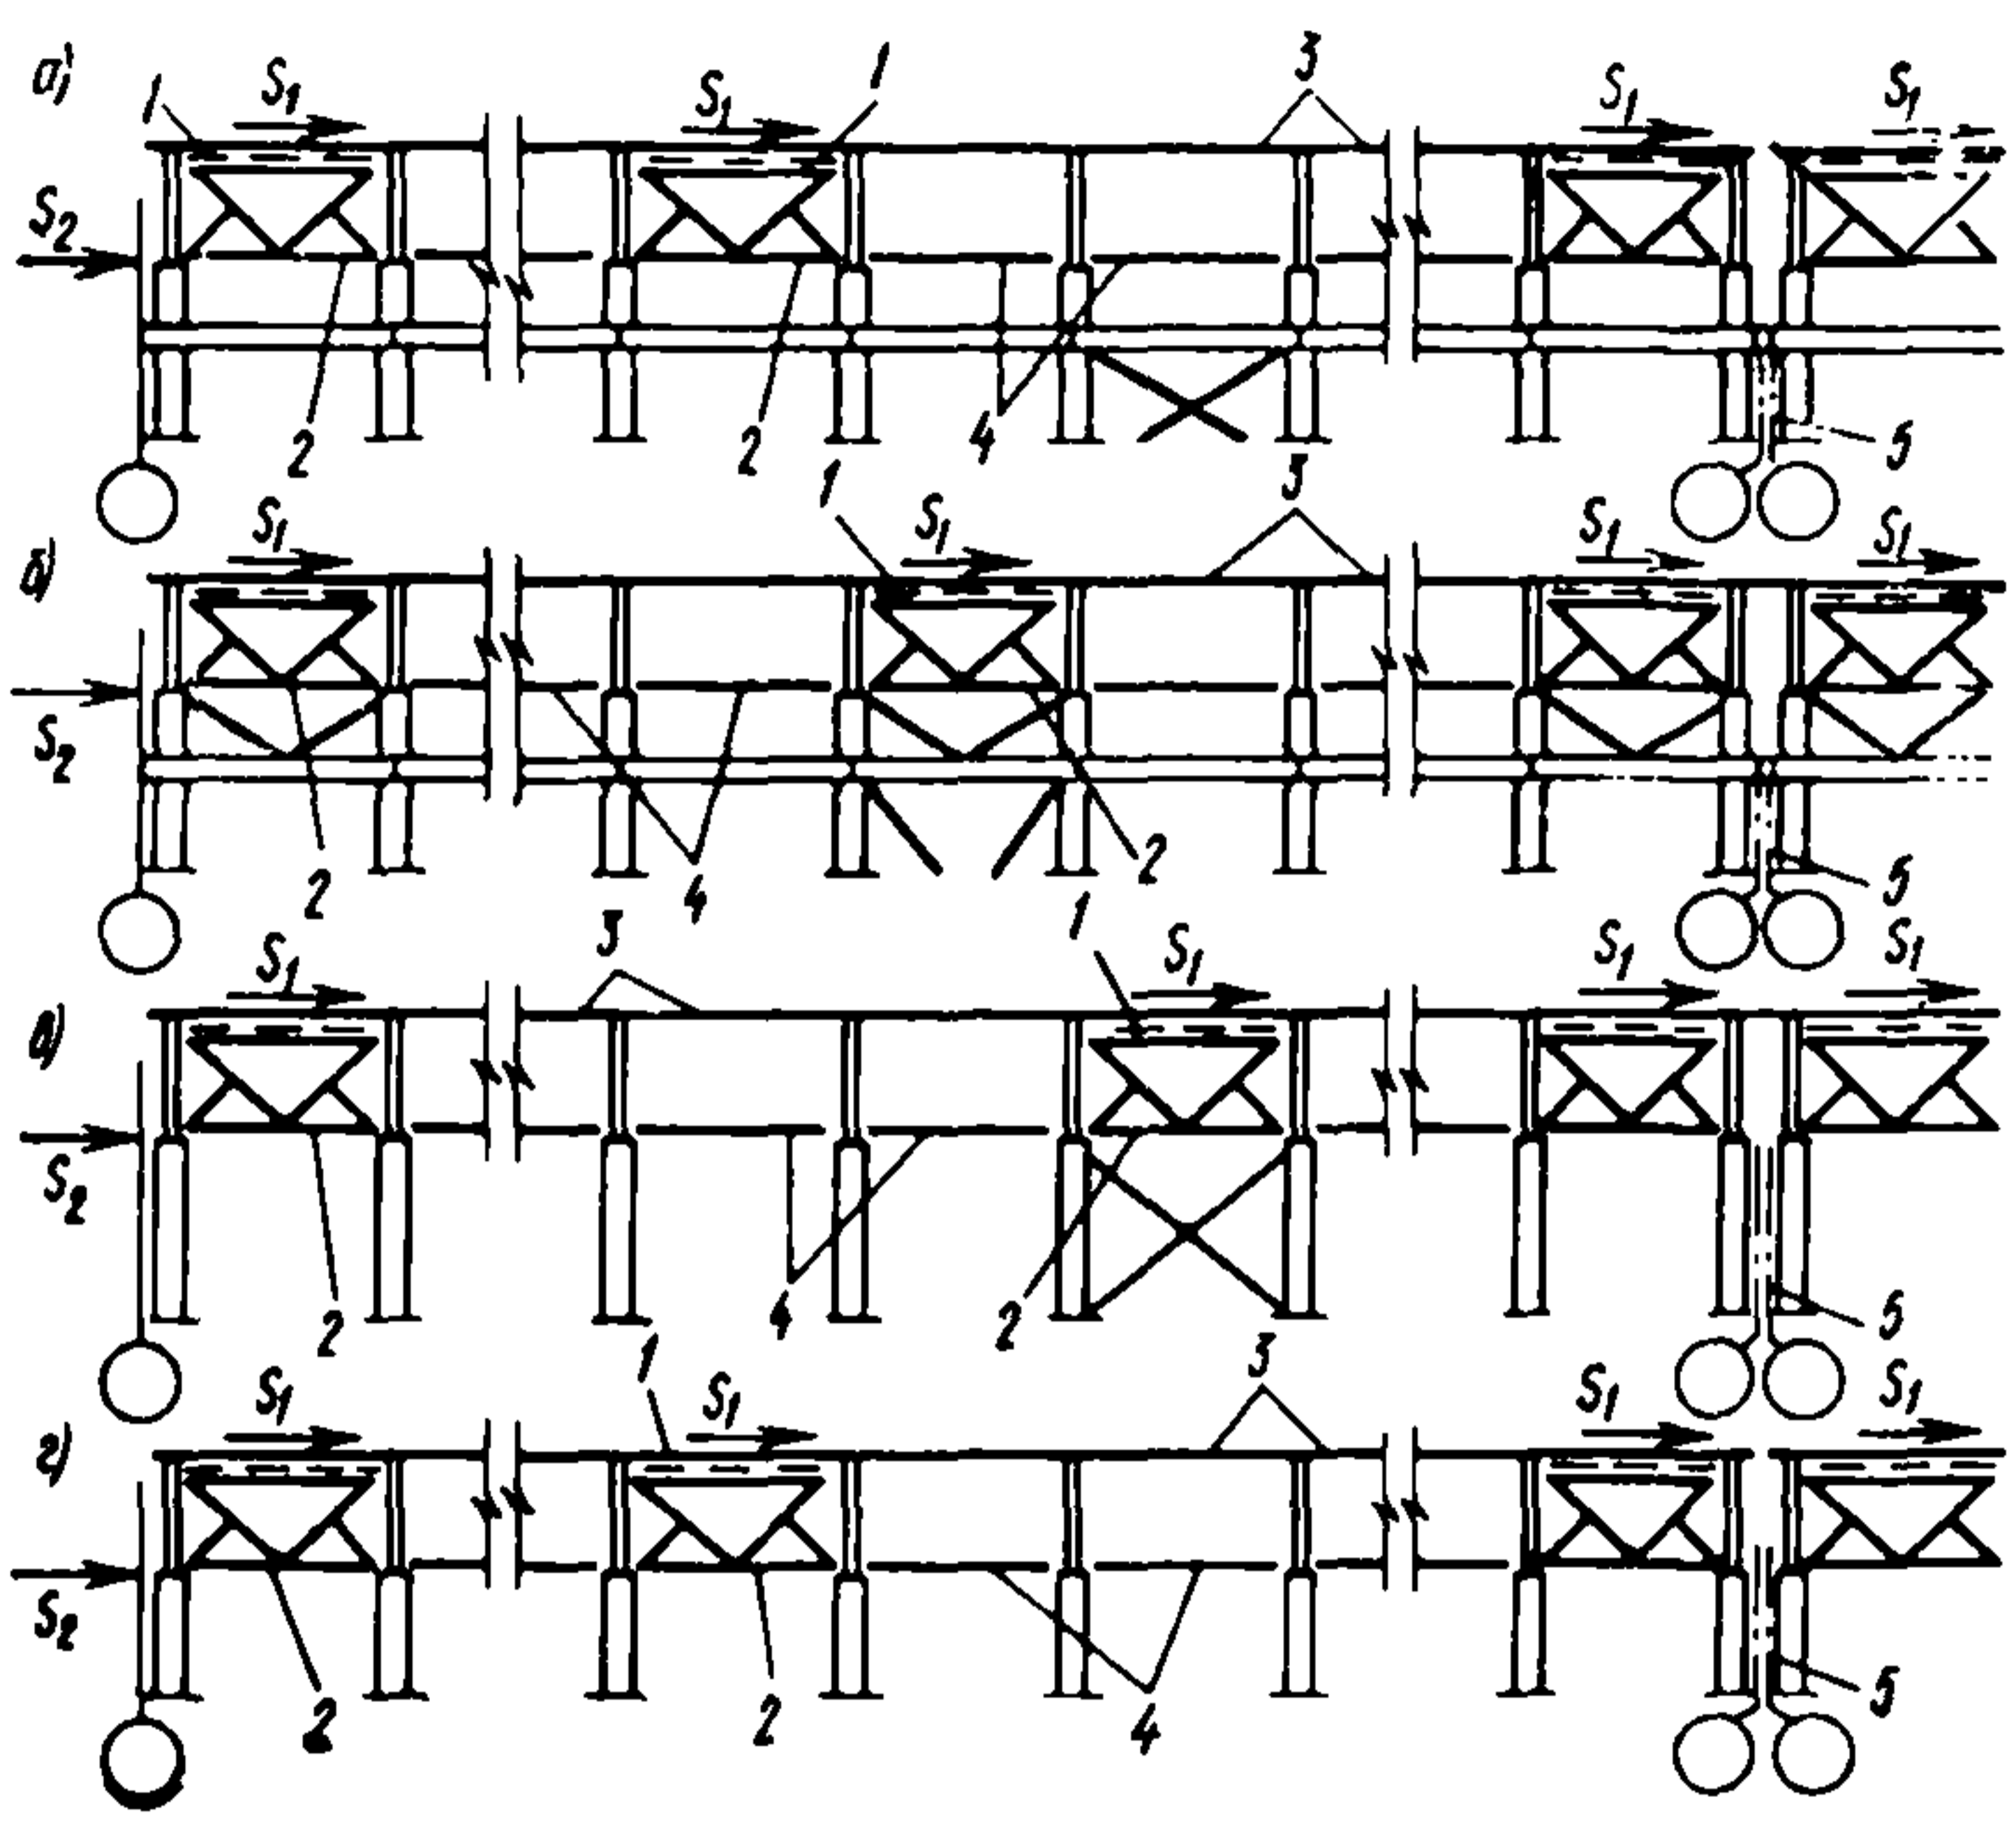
Схемы расположения вертикальных связей и распорок по продольным рядам колонн зданий с покрытиями из стального профилированного настила
